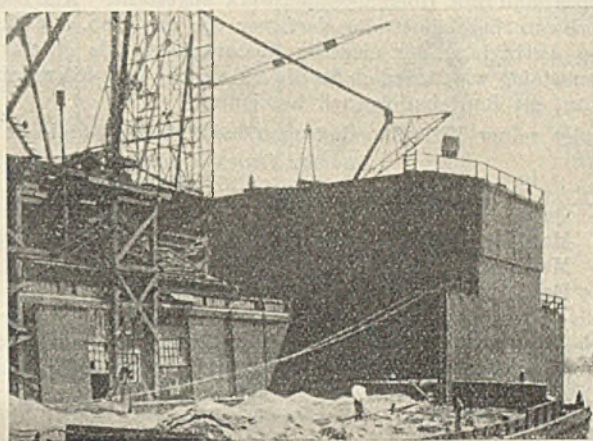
Eisenblechsenkkasten der Pfeiler vor dem Absenken.
